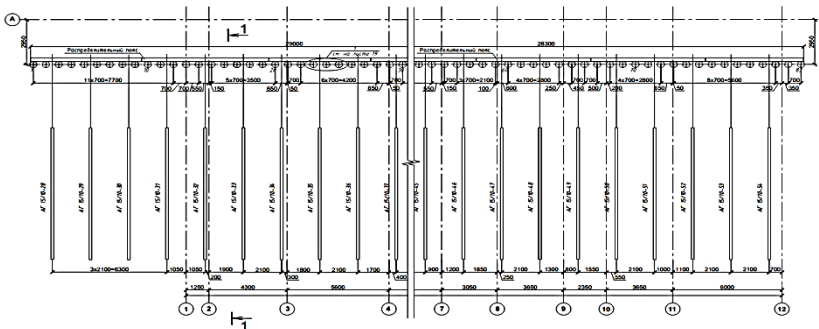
План шпунтовой стены с грунтовыми анкерами
